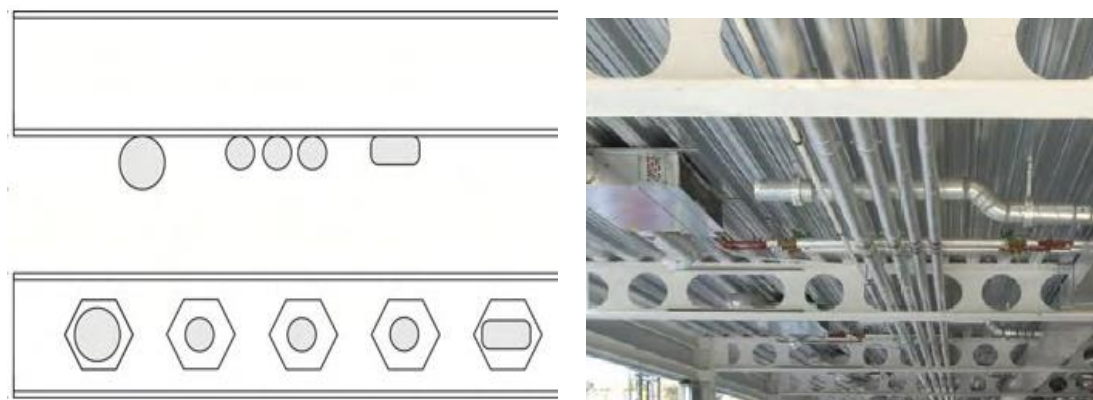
Passagem de instalações em vigas alveoladas (Oliveira, 2011; Westok, 2008)
